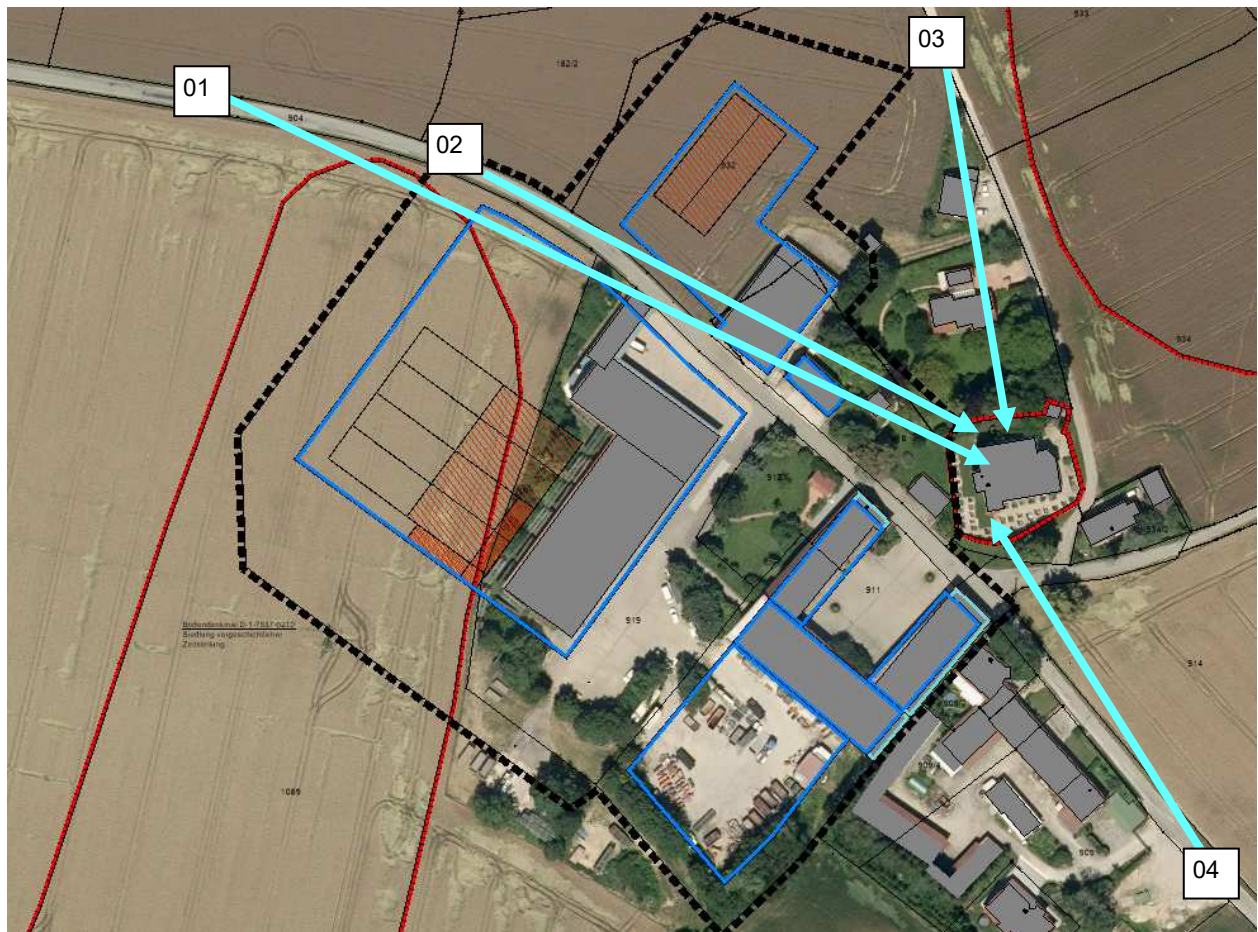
Blickbeziehungen (mit Nr. der Aufnahmestandorte nachfolgender Fotos) zur Füllialkirche mit Darstellung des Geltungsbereichs, der geplanten Baufenster, der geplanten Lage der Gebäude sowie der Abgrenzung von Bau- und Bodendenkmäler
